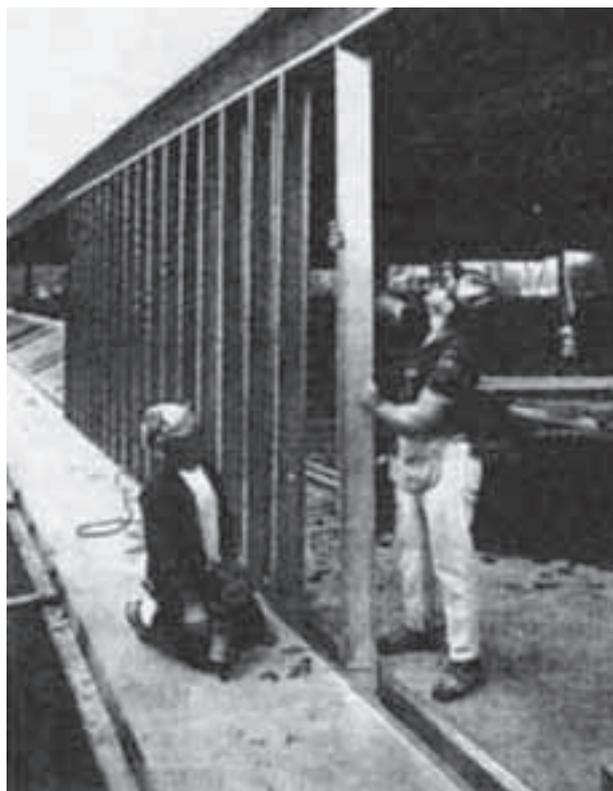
Light Steel Framing montado pelo método "stick" (Fonte: Robert Scharff)
